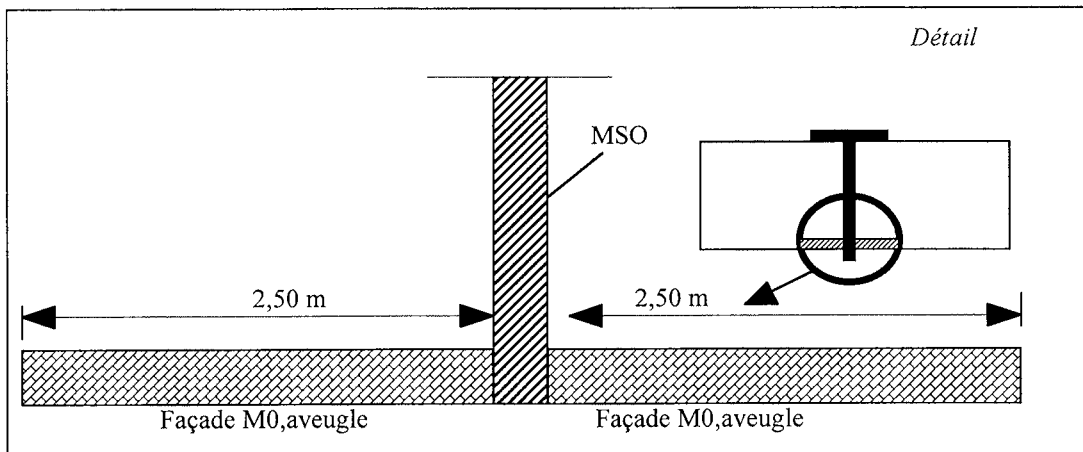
a : Conditions de non-dépassement sur les côtés d'un MSO.
